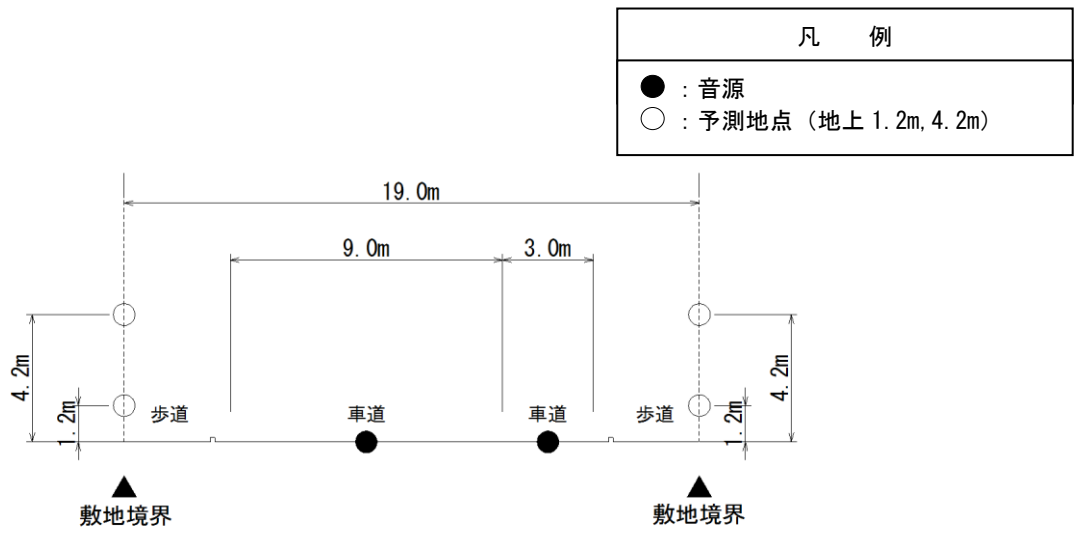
(5) 予測断面図 (E. 一般国道464号(2))
